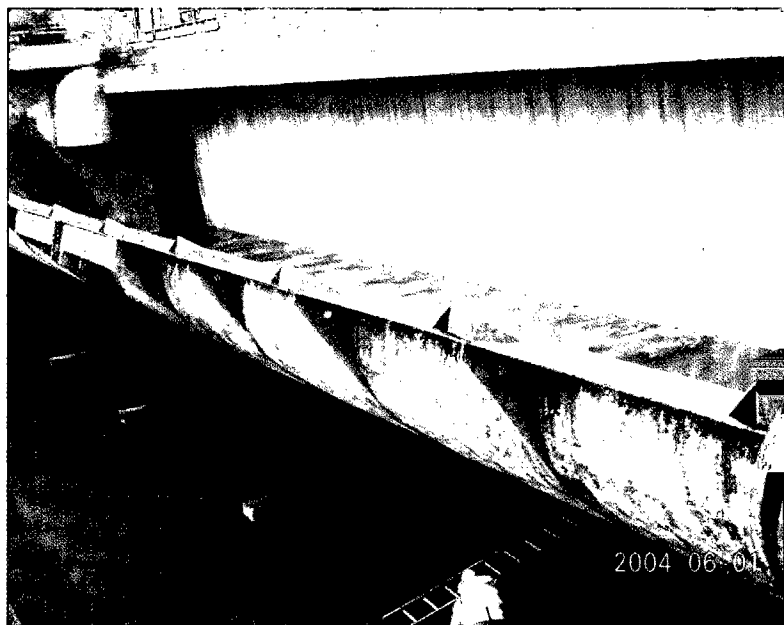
Batardeau à aiguilles supportées par une poutre supérieure
